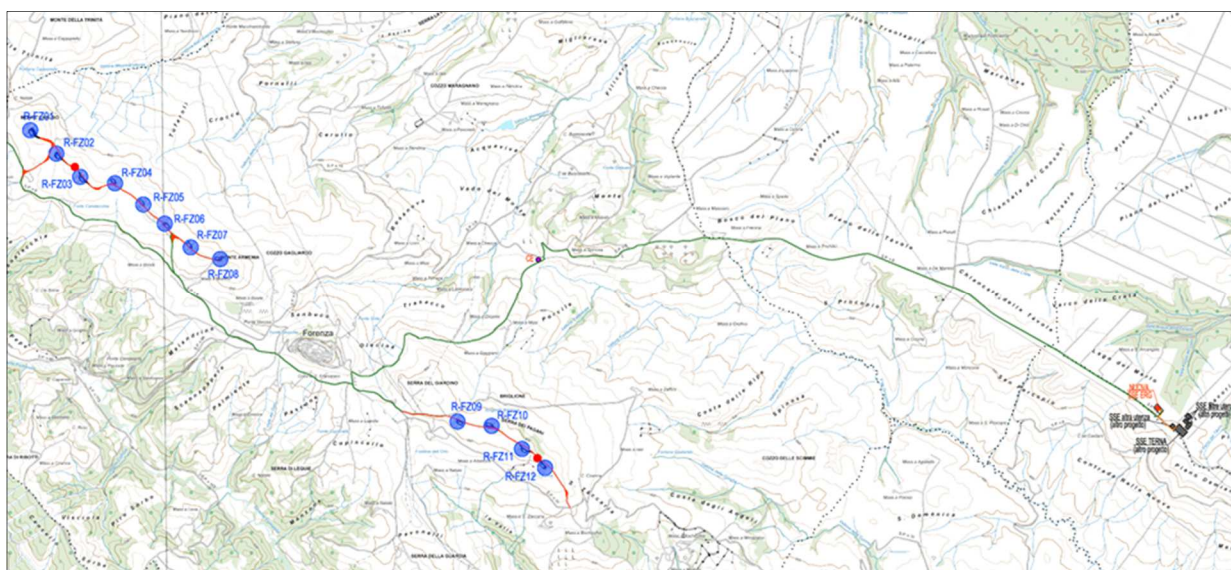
Stralcio Planimetria dell'impianto (rif. doc. A.16.a.6)
